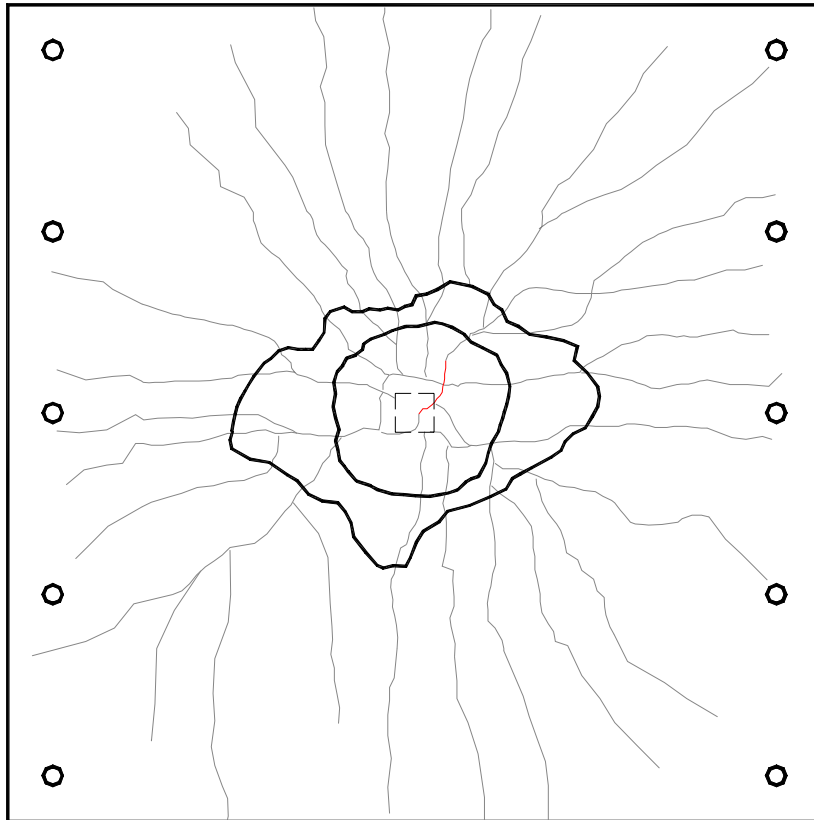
Mapa de fissuração da laje L1A
